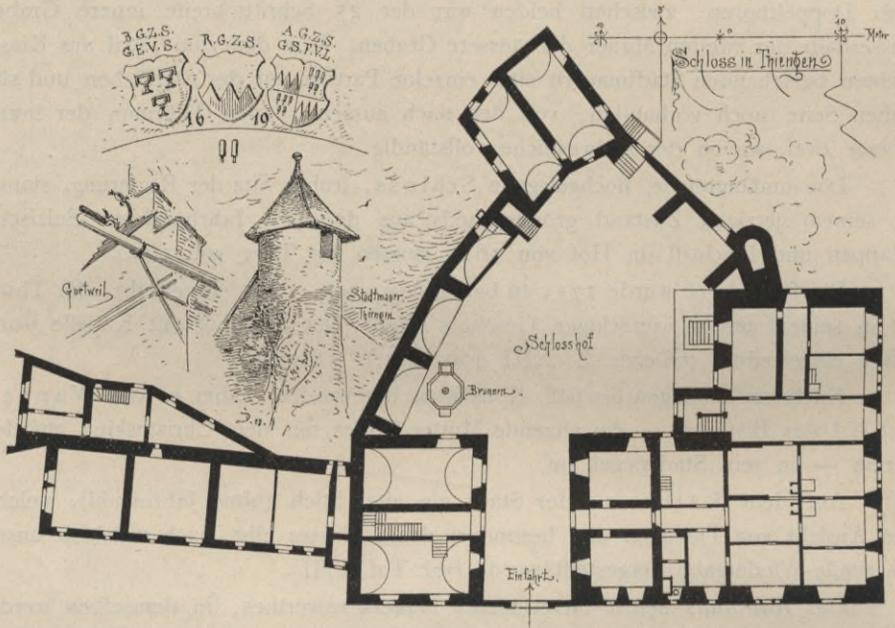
Gurtweil, Detail. — Thiengen, Grundriss des Schlosses.
